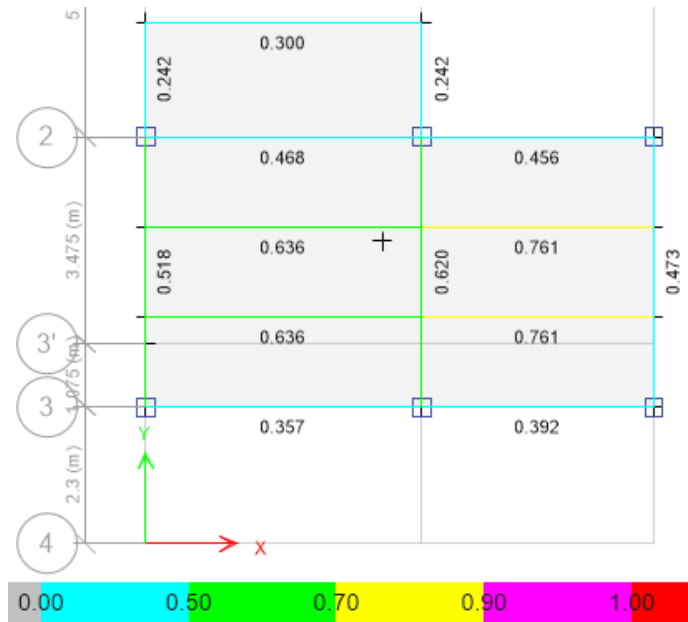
Diseño de vigas principales y secundarias de la losa del nivel +11.70
